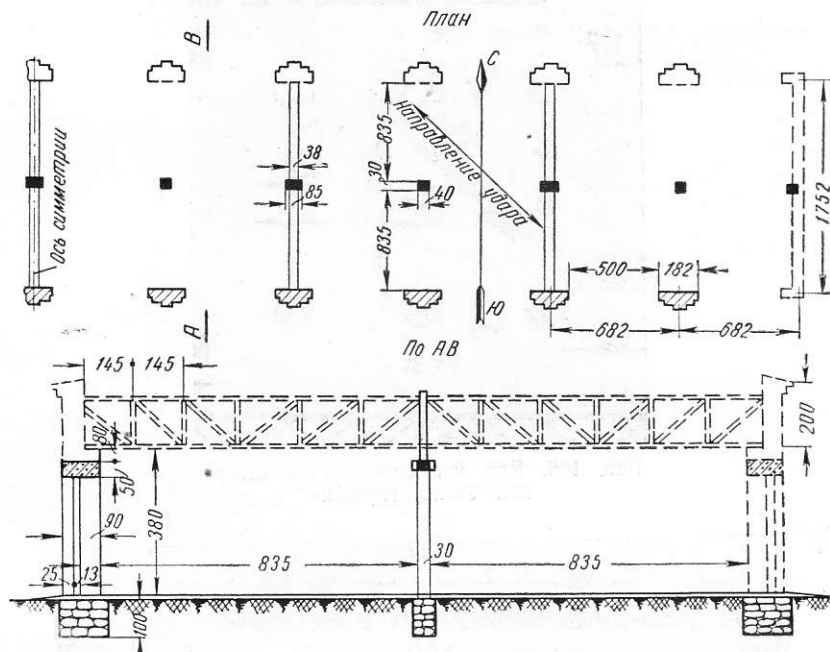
Схема плана и разреза гаража (пунктиром показаны разрушенные столбы)
